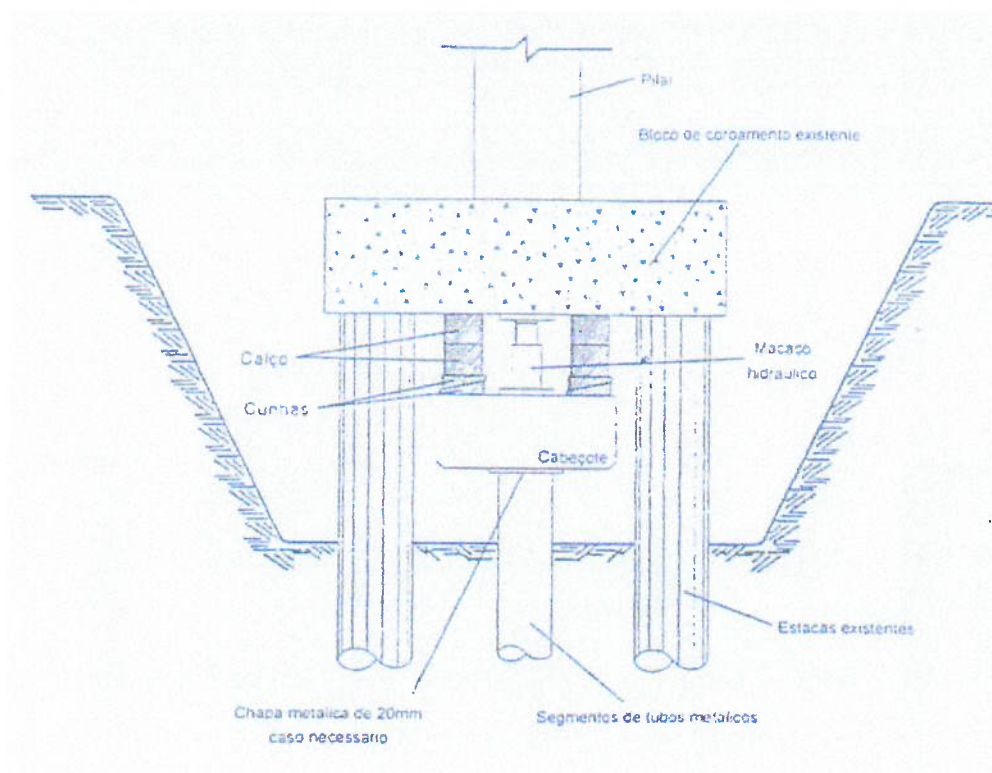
Sistema de cravação por macaqueamento reagindo na estrutura existente.
